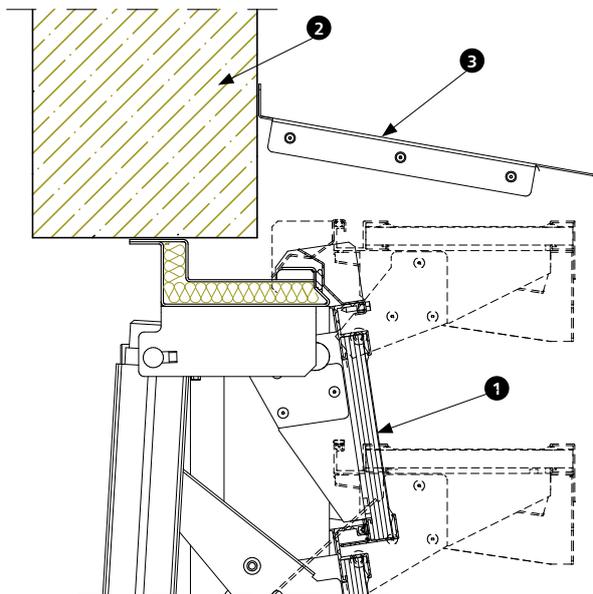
Montage des Lamellenlüfters direkt in Maueröffnung (Wand, Fassade)
